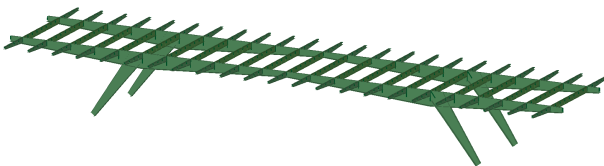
Расчетная схема моста с элементами переменных сечений / The settlement scheme of the bridge with varying cross sections elements
